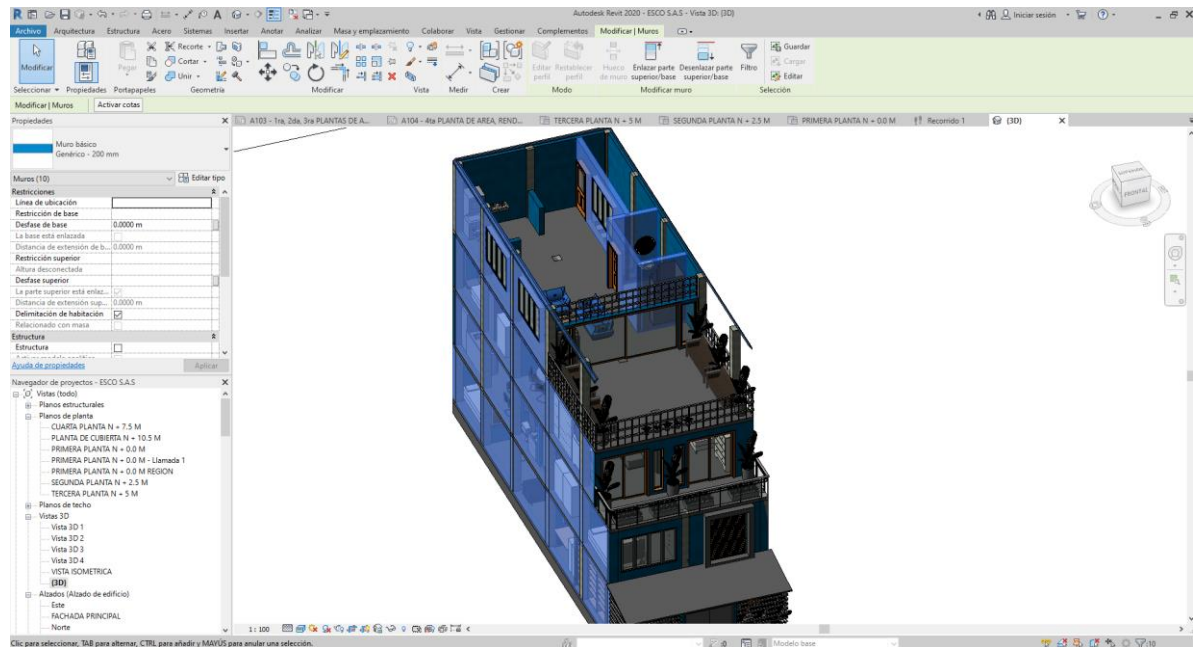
Corte de la cuarta planta. Revit. Fuente elaboración propia.
